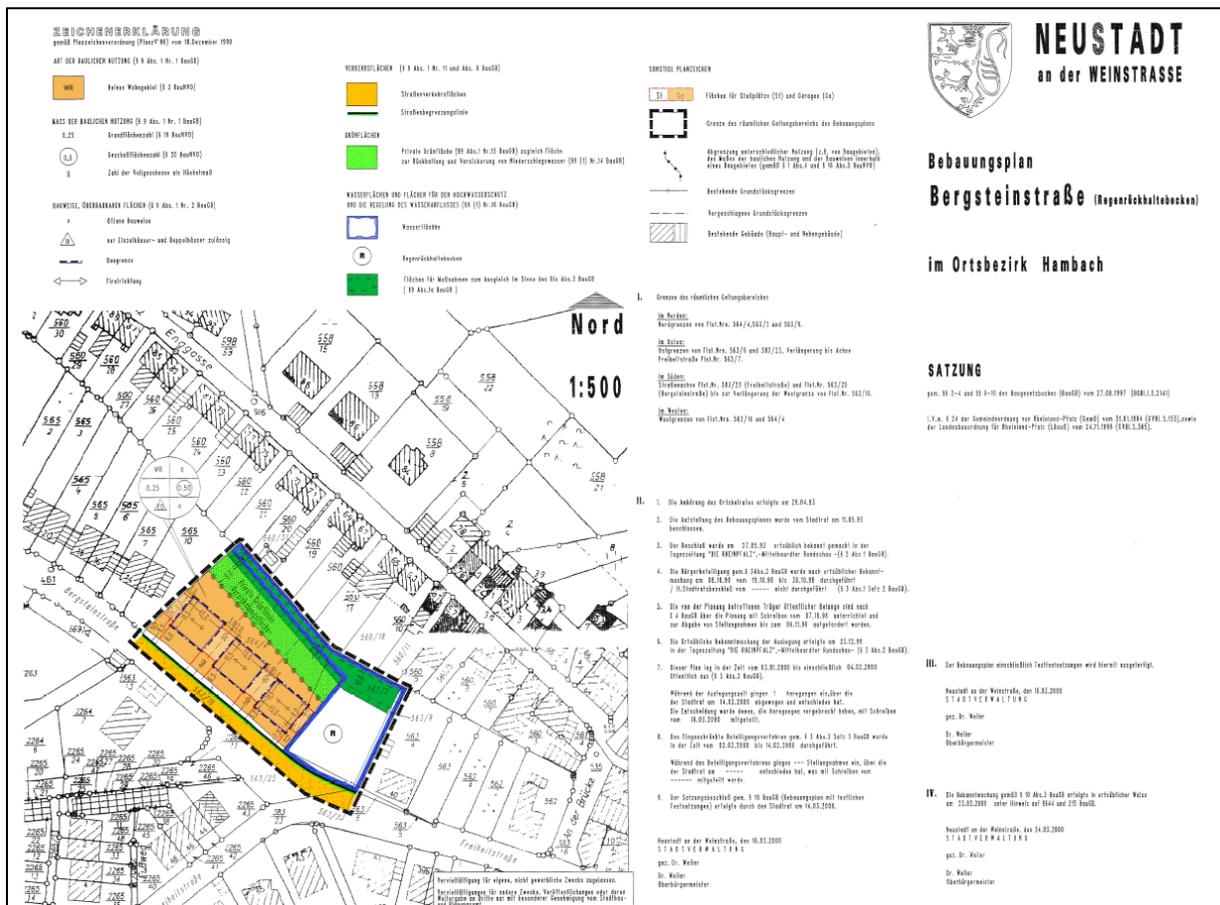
Bebauungsplan "Bergsteinstraße (Regenrückhaltebecken)"<sup>11</sup>
